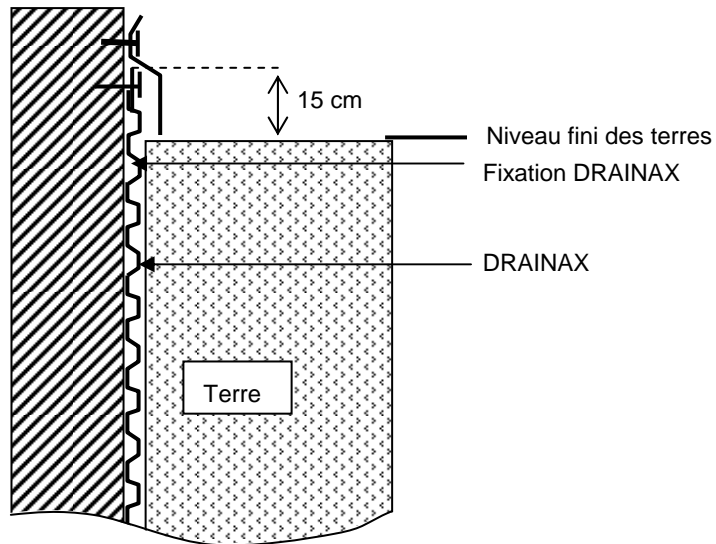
Arrêt supérieur du DRAINAX sur support nu, enduit ou revêtement d'étanchéité
